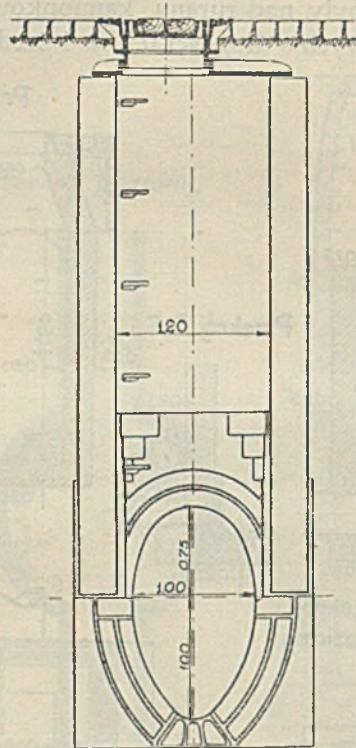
Studzienka żłazowa z betonu ubijanego w wykopie.
